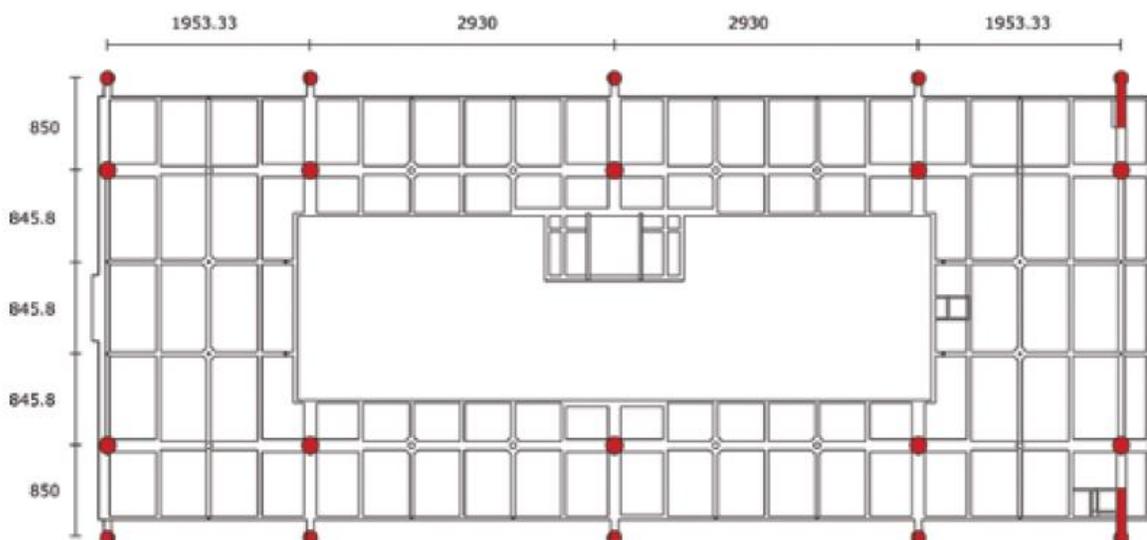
Distribuição dos tirantes estruturais no primeiro pavimento do Terminal Sacomã.
